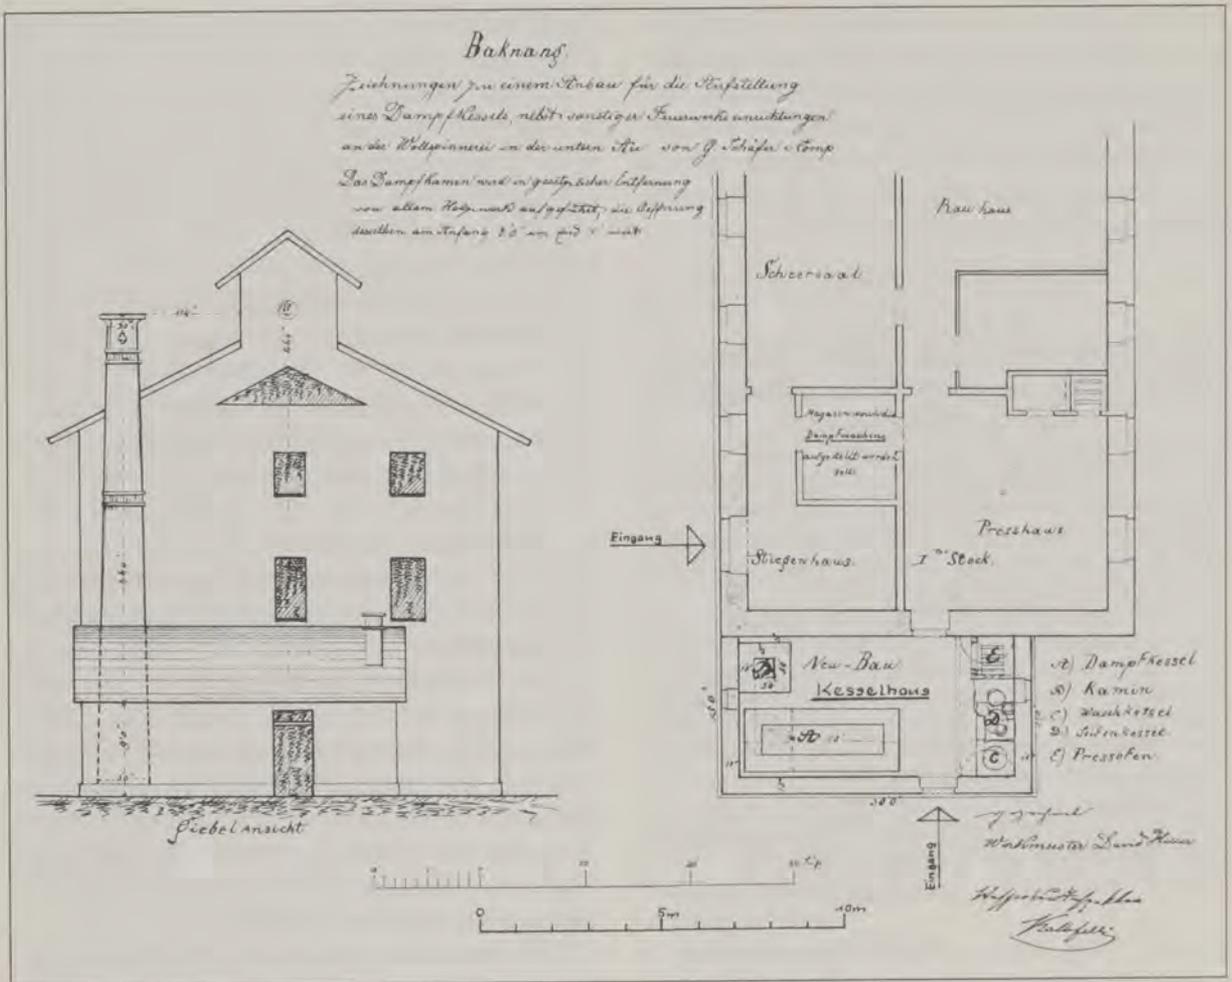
Baugesuchs-Unterlagen für den Anbau eines Kesselhauses mit Schornstein. Im Erdgeschoß-Grundriß ist der Standort der Dampfmaschine eingetragen. (Die Zeichnungen sind teilweise ergänzt worden.)
